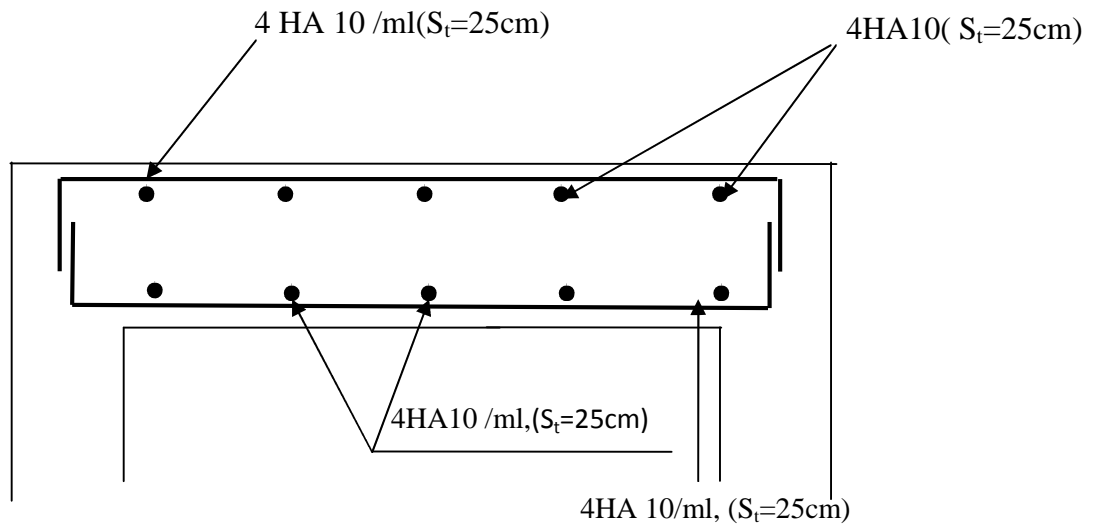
Ferrailage de la dalle pleine de la salle machine dans le sens x-x.
